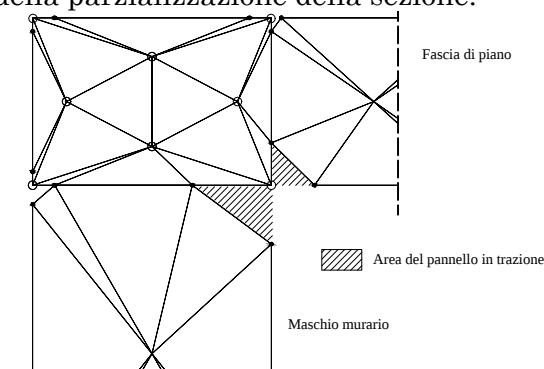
Assemblaggio di un maschio murario e una fascia, mediante l'interposizione di un elemento di collegamento, in configurazione variata
